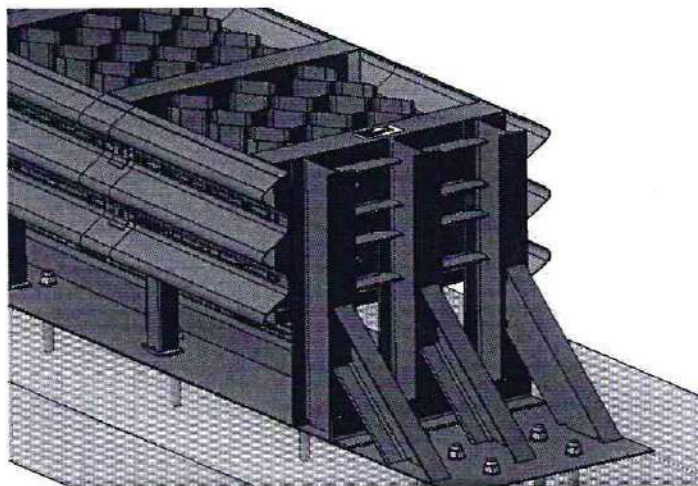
Расположение маркировочной бирки на ФО-Д(М)-У2-П-90-0,874x6,56x0,83
